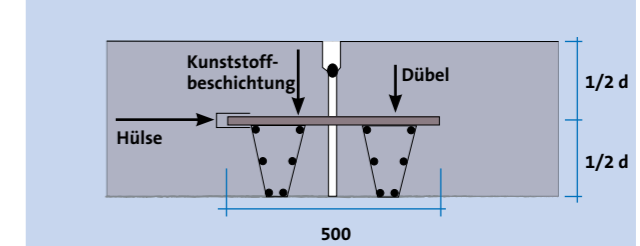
Bewegungsfuge/Raumfuge mit Verdübelung
